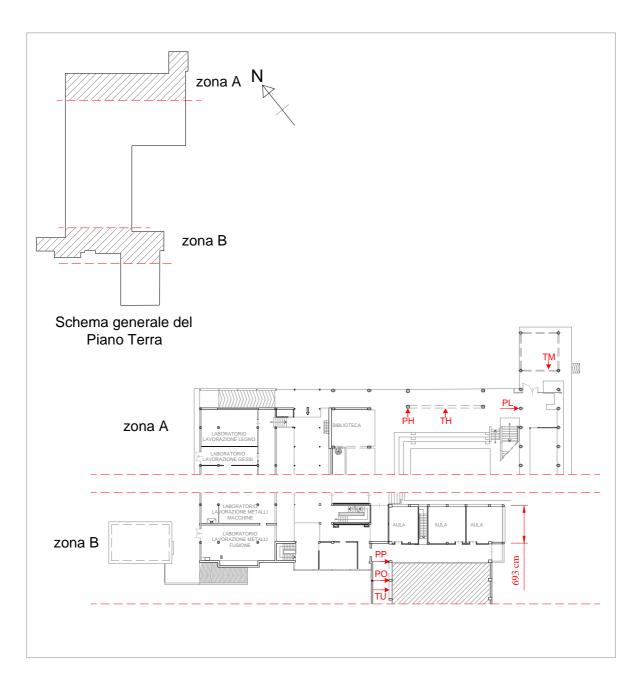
Planimetria schematica del piano terra dell'edificio.
